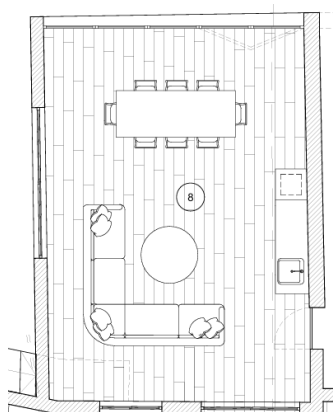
Zona exterior coberta, excerto da planta de apresentação
